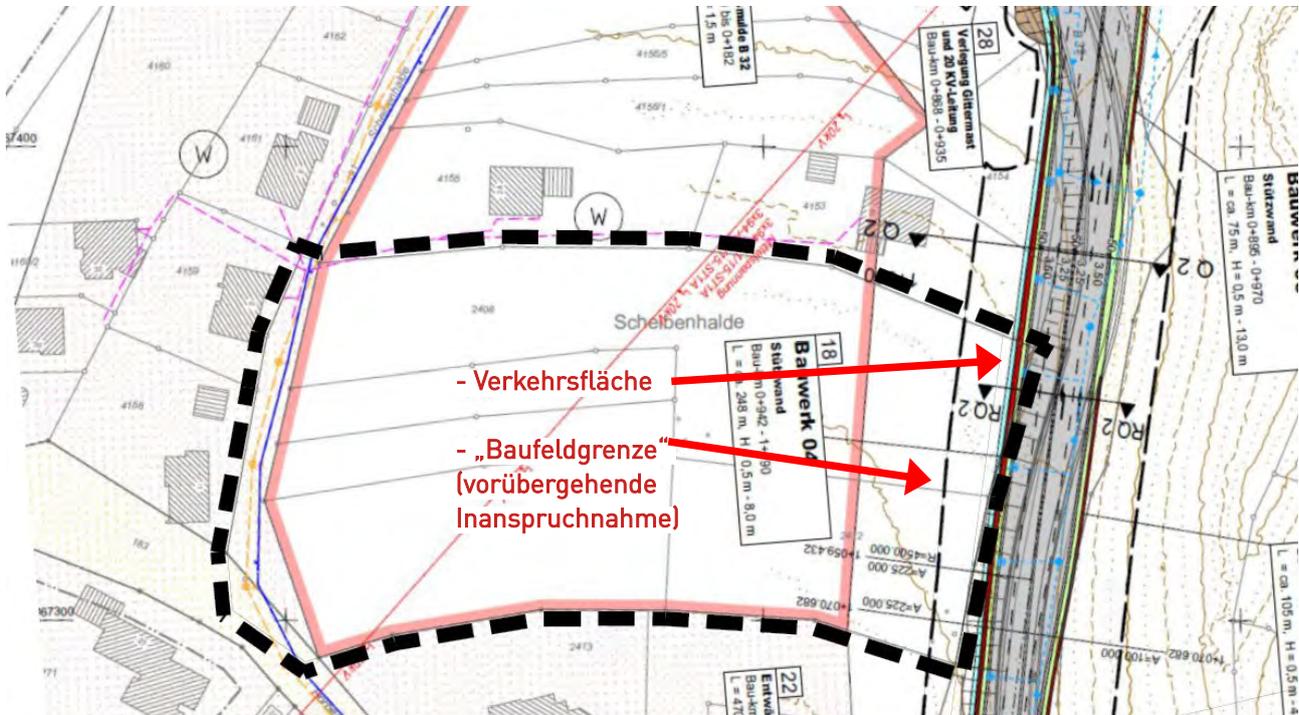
Lageplan Planfeststellung B32 OU Horb vom 08.12.14 RP Karlsruhe mit Plangebiet (schwarz gestrichelt)
